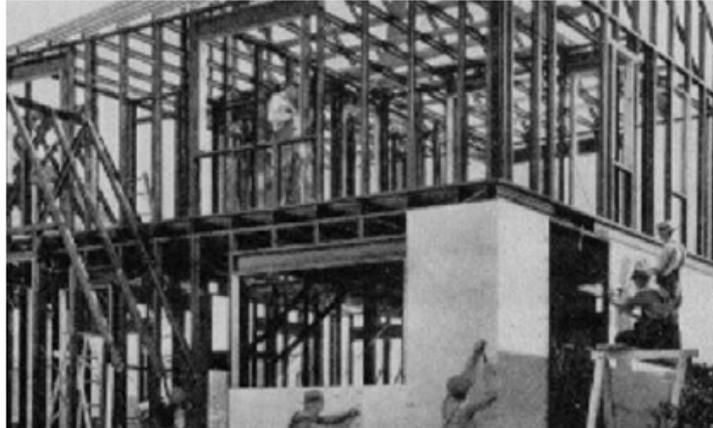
Primer prototipo de steel-Frame, Chicago, 1933; Fuente: Manual steel Framing (Alacero)
